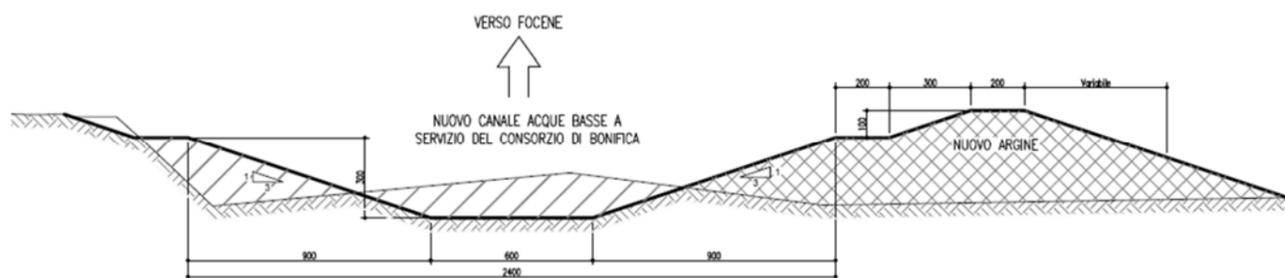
Sezione trasversale Nuovo Canale Acque Basse
